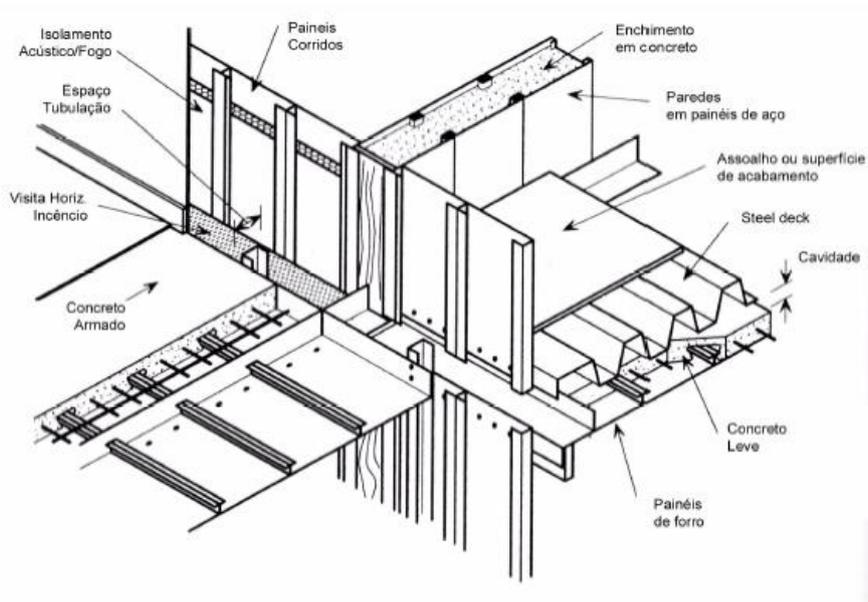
Sistema Shutter (ALVARENGA, 2002, p. 75)
